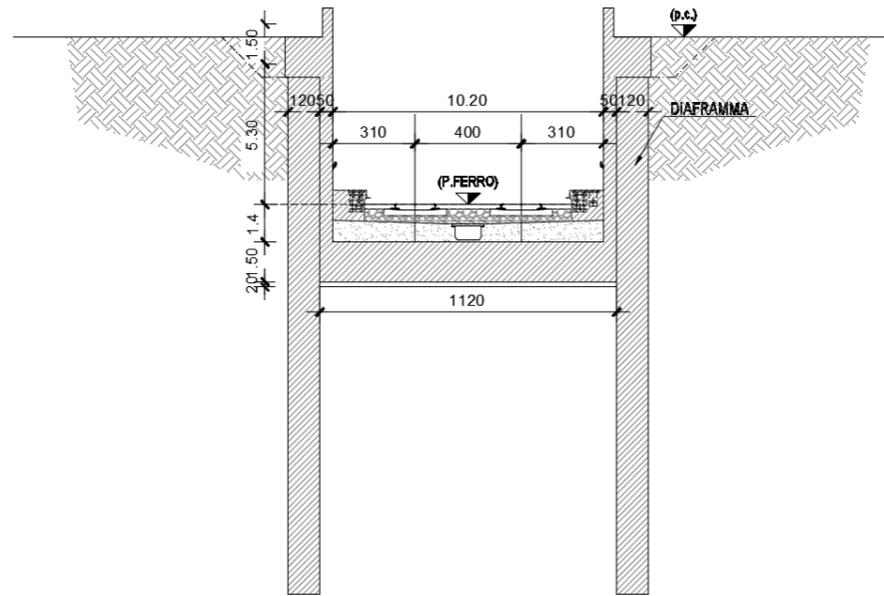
Trincea tra diaframmi TR03 – Sezione Tipo
